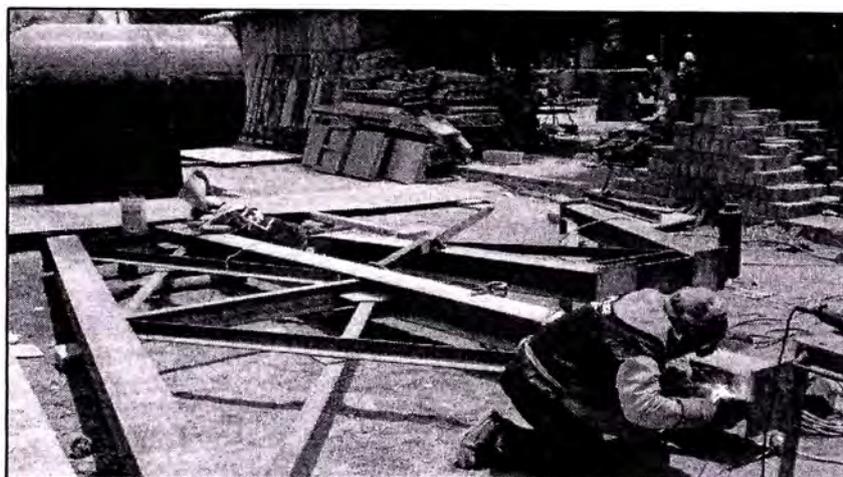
Fabricación de Estructuras -Taller de Obra Puno
